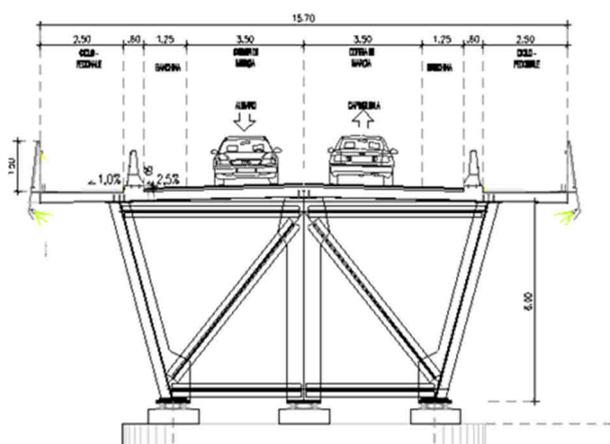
Nuovo ponte sul Magra. Sezione di Pila.
